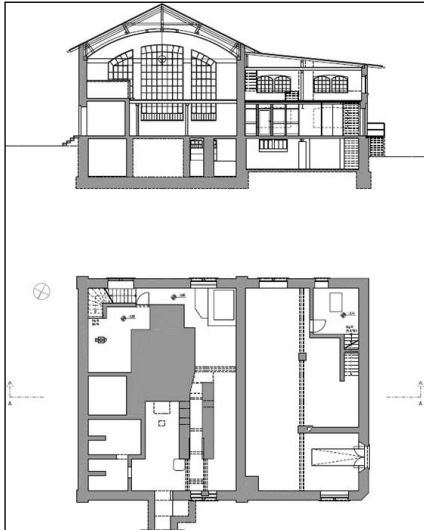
Schnitt und Grundriss des ehemaligen Dampfturbinenhauses von ADC. Fundamentebene mit unterirdischer Wasserzuleitung. Der Raum war ursprünglich offen. (Quelle: Bauaufnahme Hochschule Zittau/Görlitz 2004)
